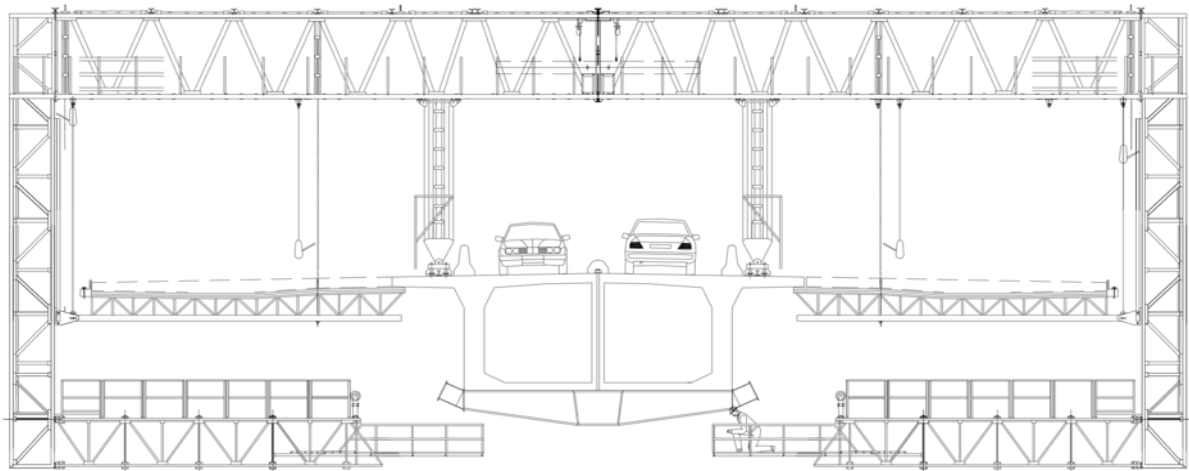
FASE 1- Encofrado móvil dispuesto sobre el tablero para la colocación de la estructura metálica y el hormigonado de la nueva losa.
